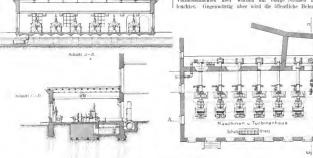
Grundriss und Schnitte des Maschinenhauses.
